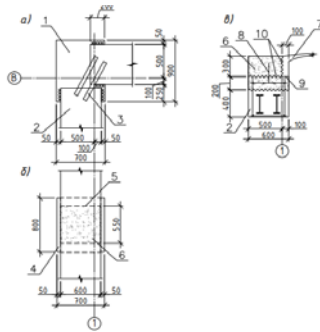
Узлы опирания сборной пологой оболочки положительной гауссовой кривизны *а* – контурных балок на угловую колонну; *б* – то же, на рядовую колонну; *в* – сборной панели на контурную балку; 1 – угловая колонна; 2 – контурная балка; 3 – стальные накладки по верху контурных балок; 4 – рядовая колонна; 5 – торец контурной балки; 6 – монолитный бетон; 7 – панель; 8 – стальной упор; 9 – закладные детали панели и контурной балки; 10 – шпонки
